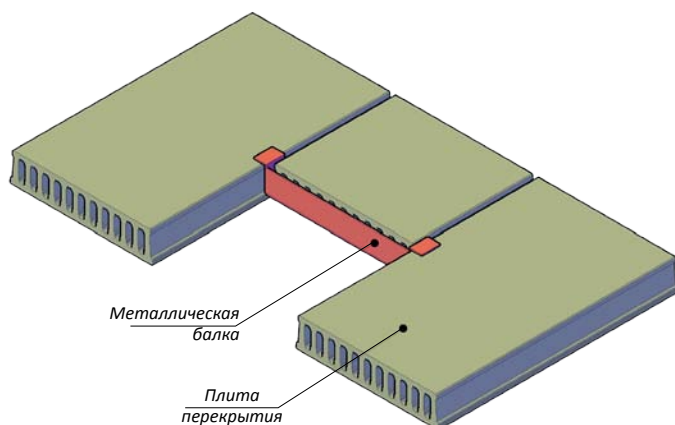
Опора многопустотного перекрытия на металлическую балку.
